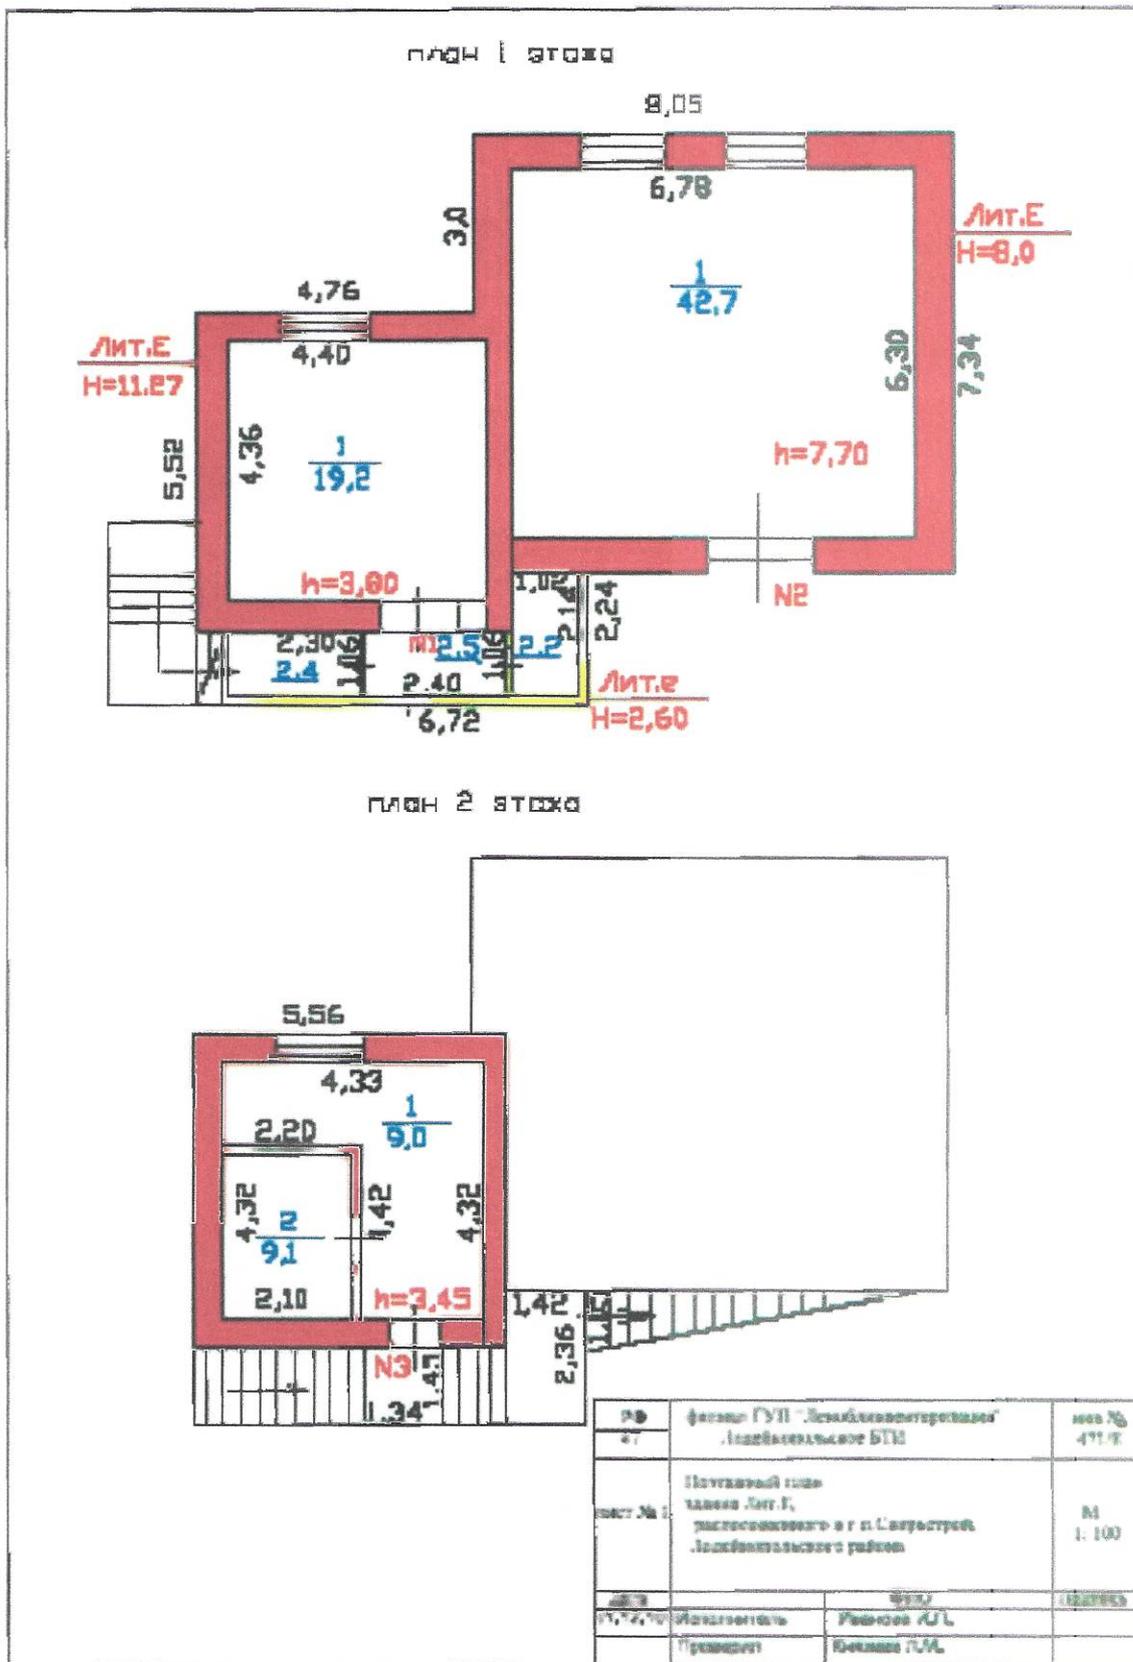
поэтажный план здания Лит. Е (1 и 2 этажи)
